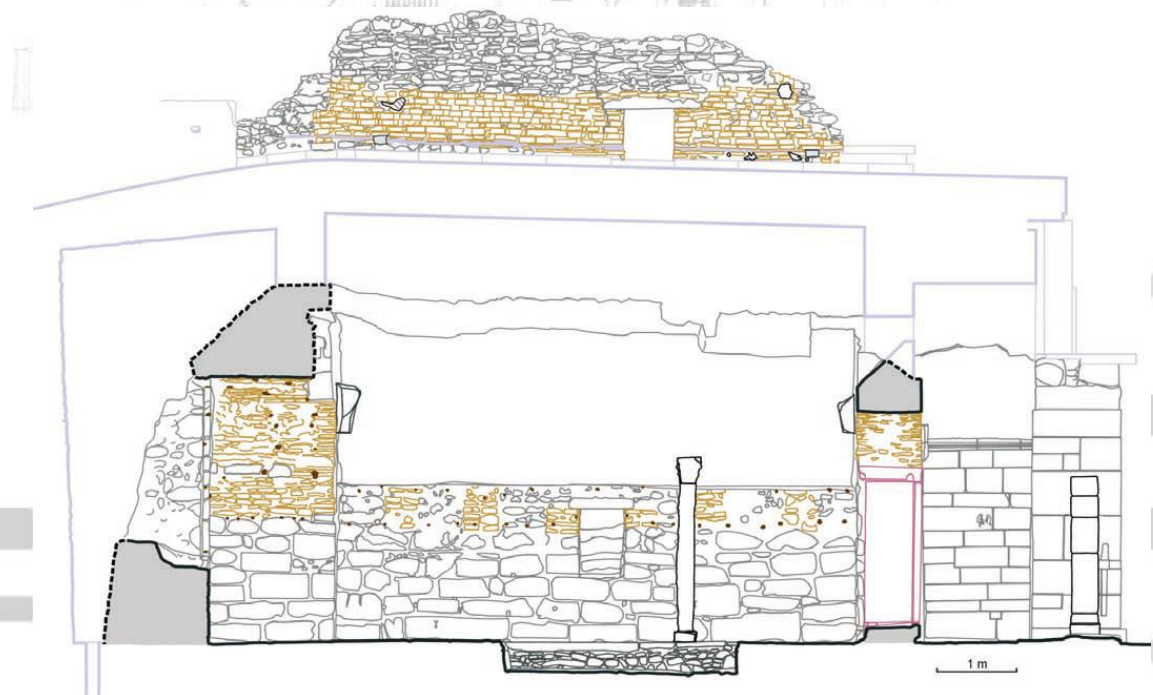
Santa Eulalia de Bóveda (Lugo). Alzado Norte delineado en AutoCAD. (MAÑANA-BORRAZÁS et al., 2008)
